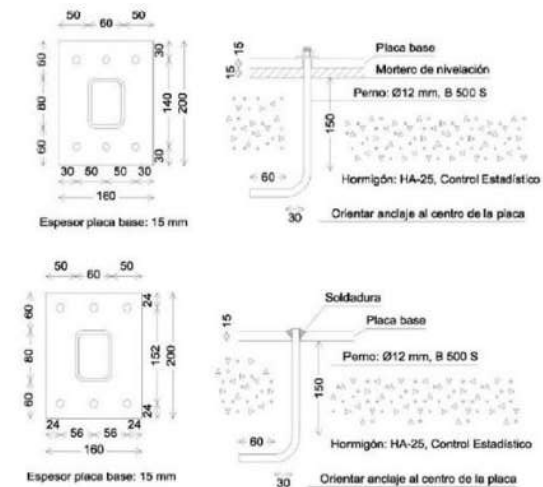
Placa de anclaje sobre mortero con pernos atornillados y placa de anclaje embebida con pernos soldados
